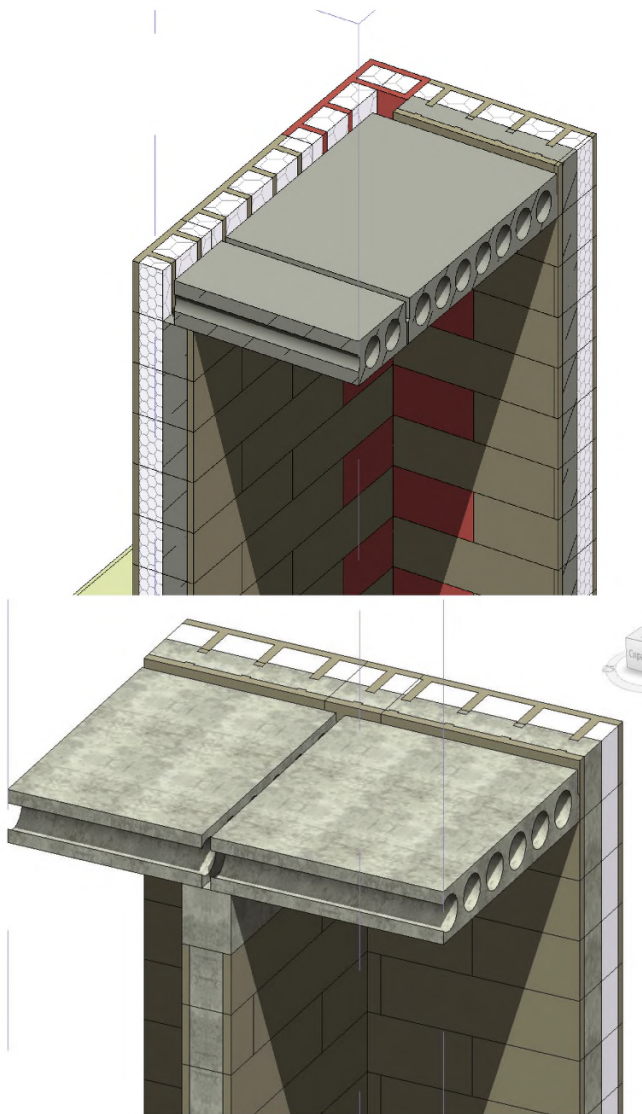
Варианты сопряжений сборных плит перекрытий с кладкой наружных и внутренних стен
